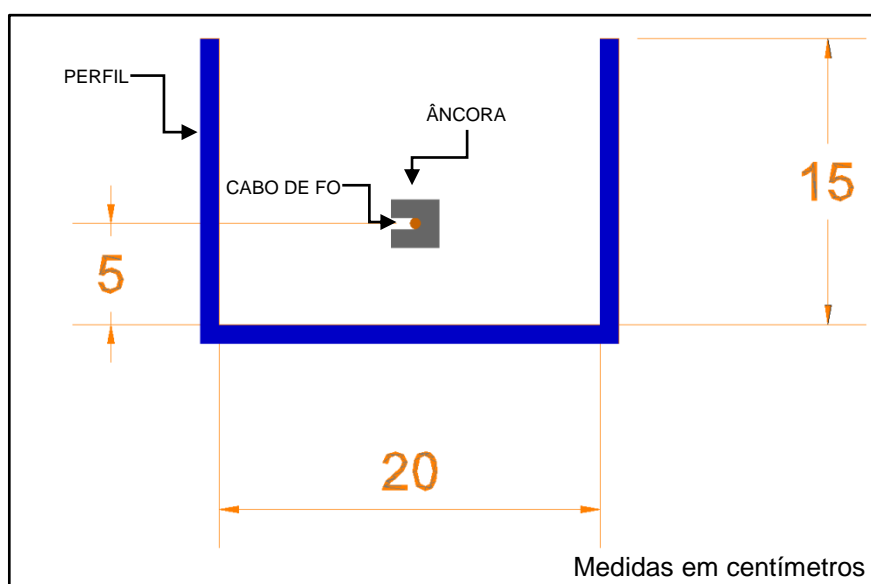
SEÇÃO TRANSVERSAL DO PERFIL METÁLICO
